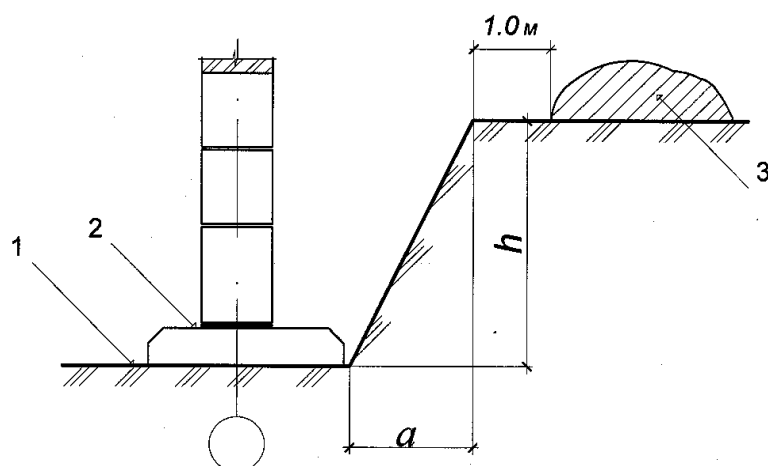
Схема определения крутизны откоса котлована: 1 – дно котлована; 2 – проектируемый фундамент; 3 – извлекаемый грунт
